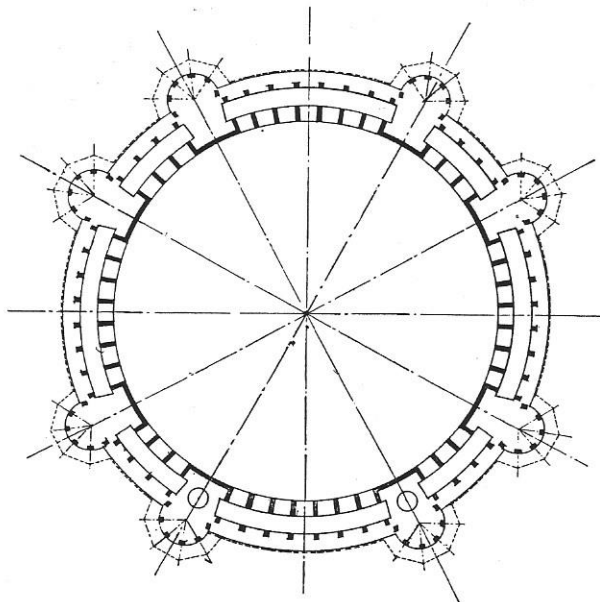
Plan au niveau du triforium. Les escaliers d'accès au triforium sont aménagés dans les deux clochetons Nord-Est.
